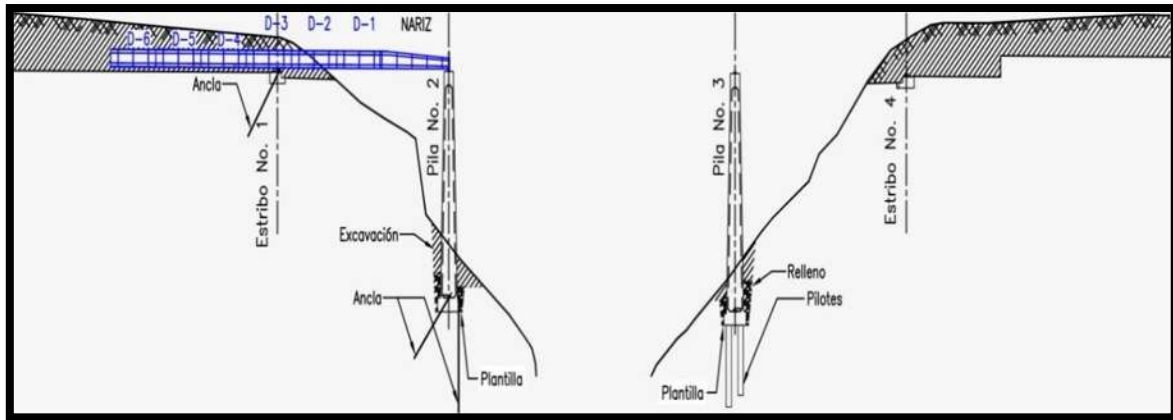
Nariz de lanzado apoyada en pila N° 2.
